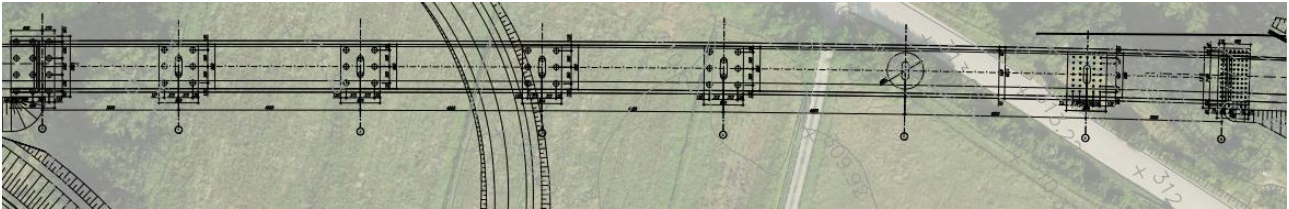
Pianta fondazioni carreggiata direzione Fano
